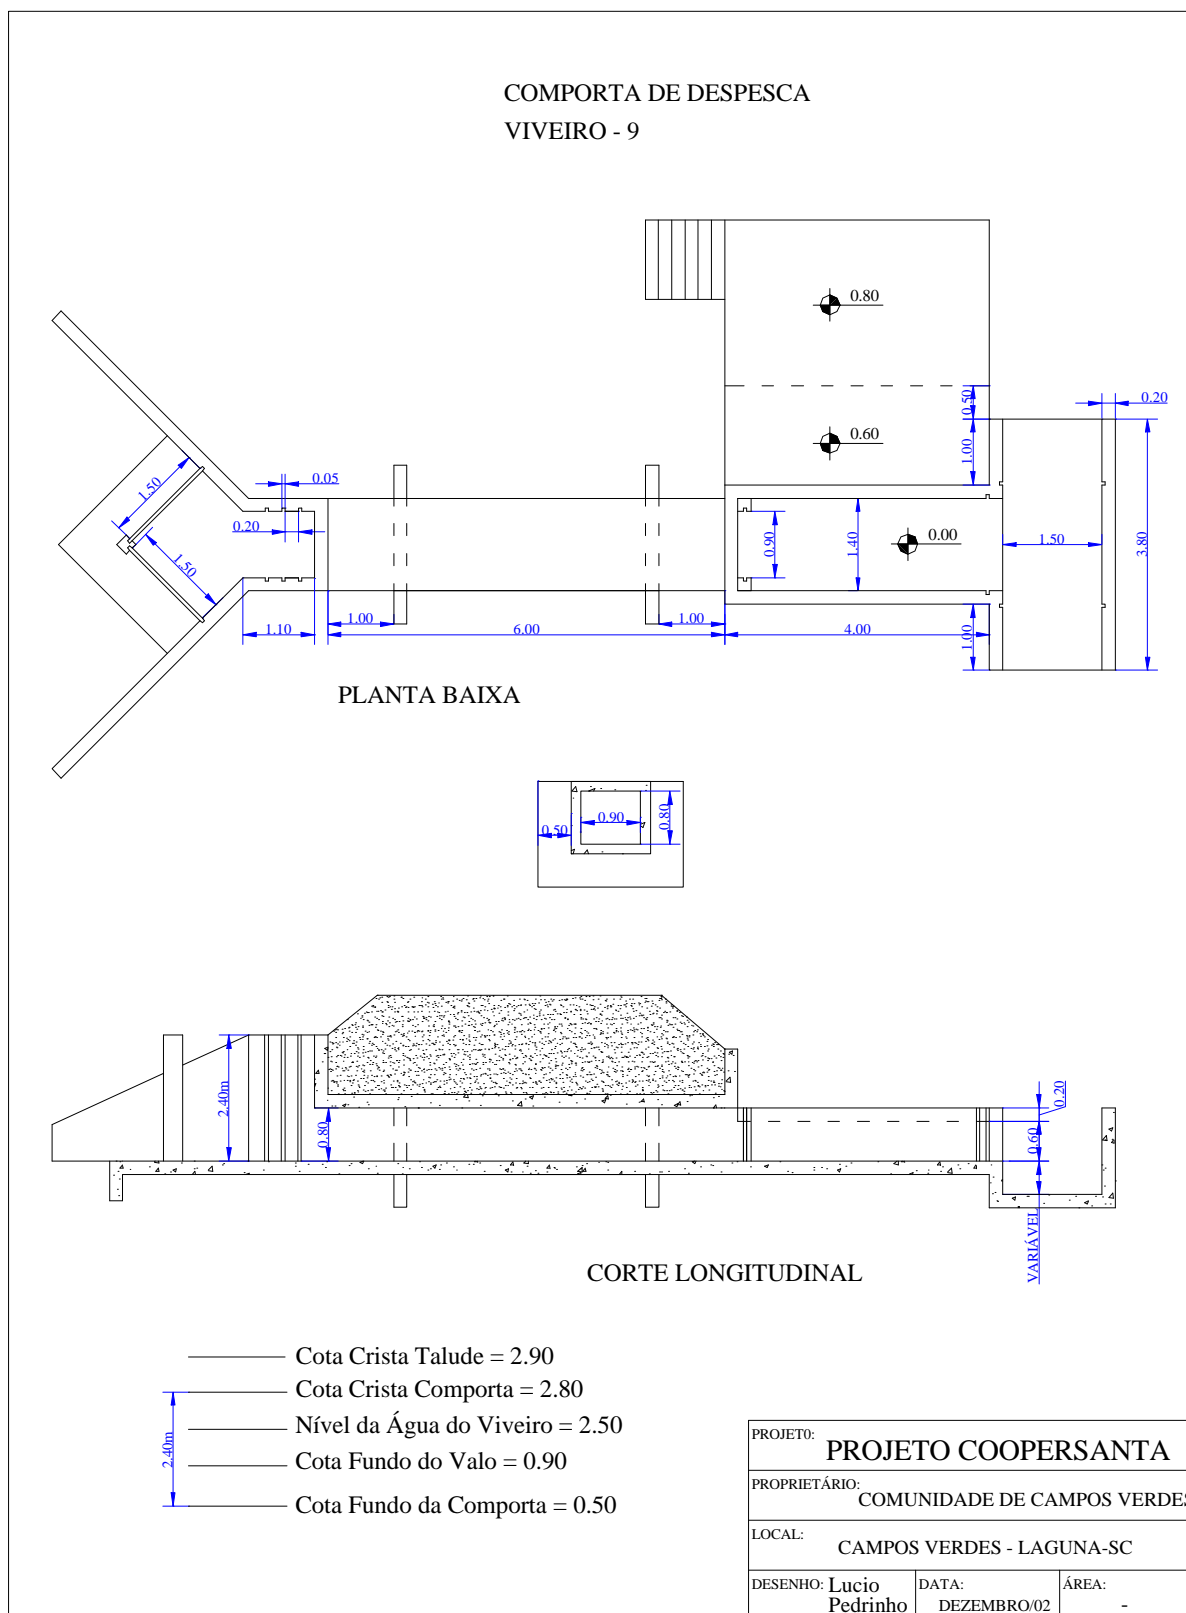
Planta baixa e corte longitudinal da comporta de drenagem (despesca), projeto COOPERSANTA, módulo I.
